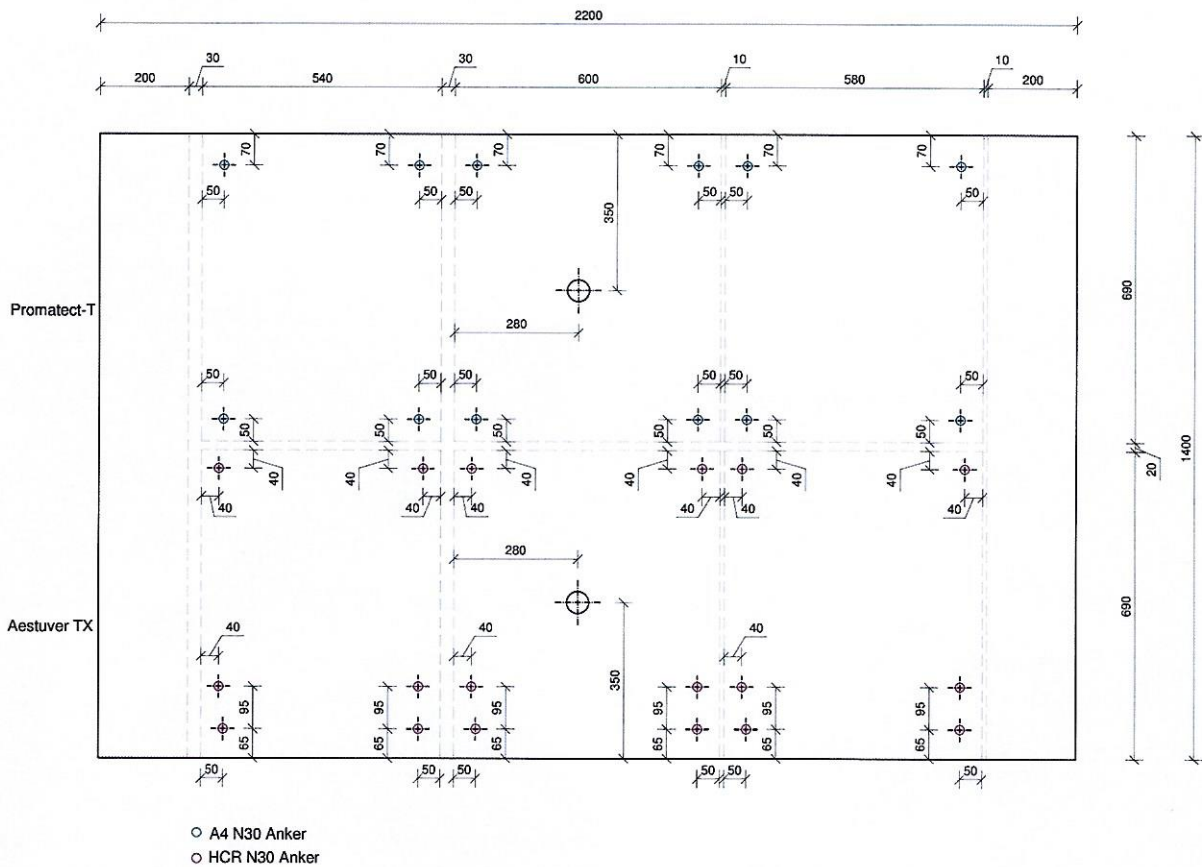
Detailzeichnungen der Anbringung der Brandschutzplatten; Draufsicht von oben
